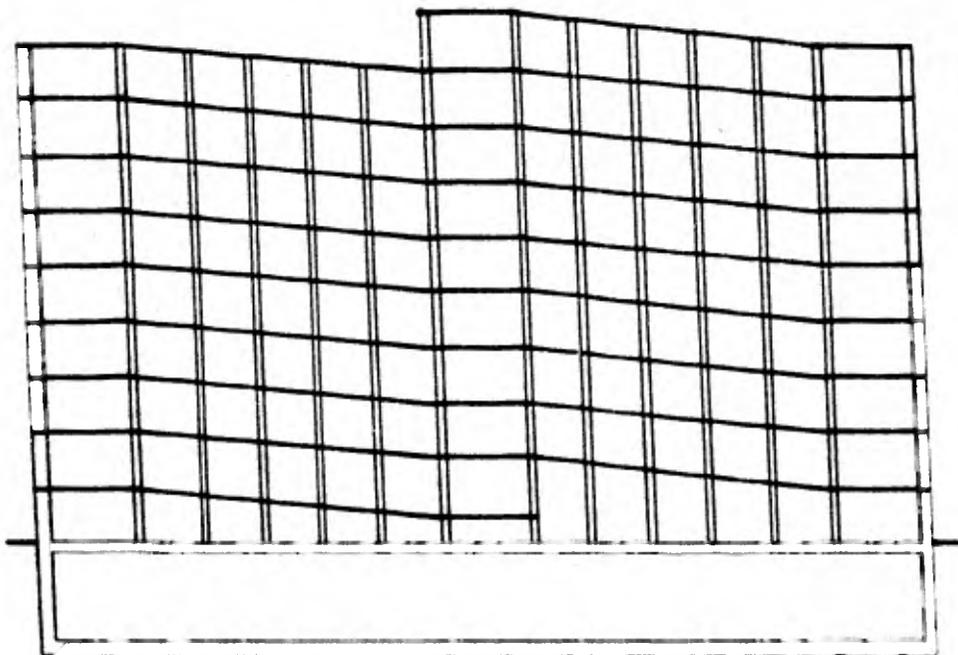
Corte esquemático longitudinal del edificio. Solución colado en sitio.
